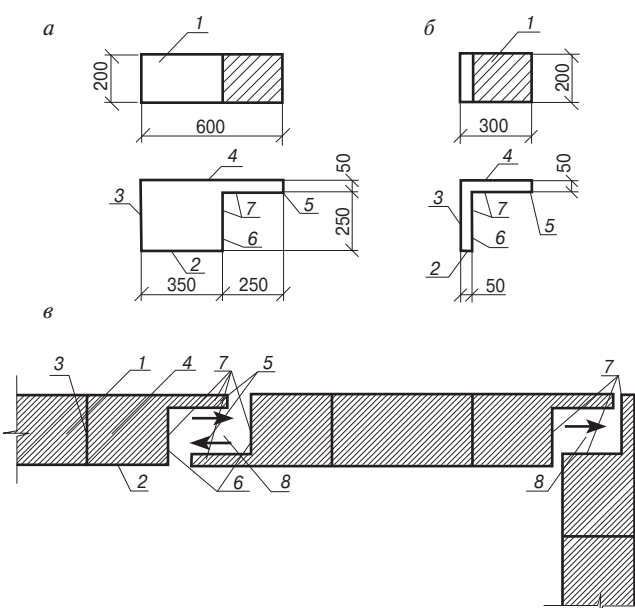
Строительный блок: а – основной; б – половинный; в – схема кладки в плане
